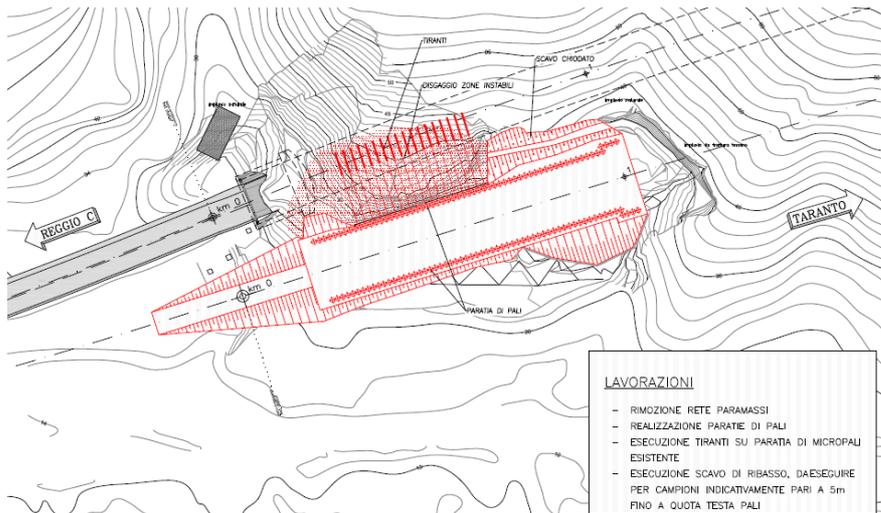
Galleria Palizzi – Fase 1 – Lato RC
